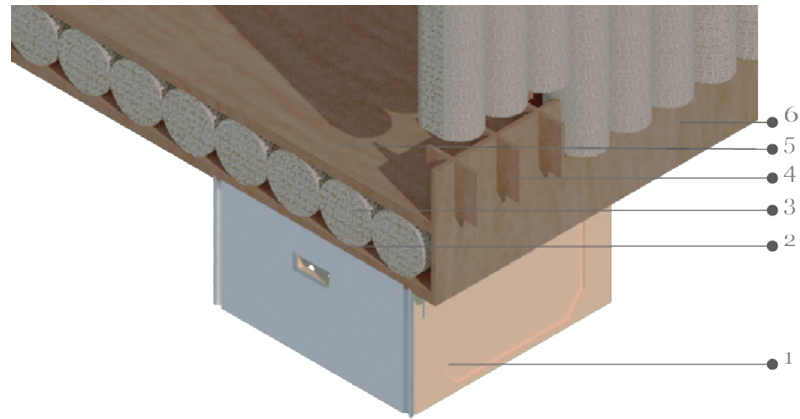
Detalle arquitectónico anclaje de tubos. Elaboración: Autores.
